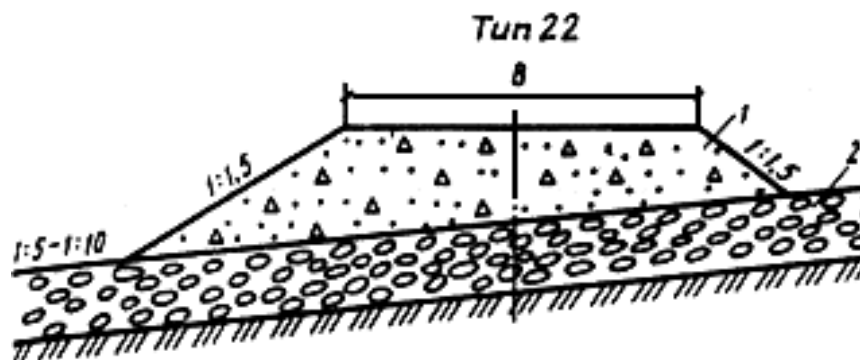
Поперечный профиль насыпи на курумах: 1 – грунт насыпи; 2 – курумы
